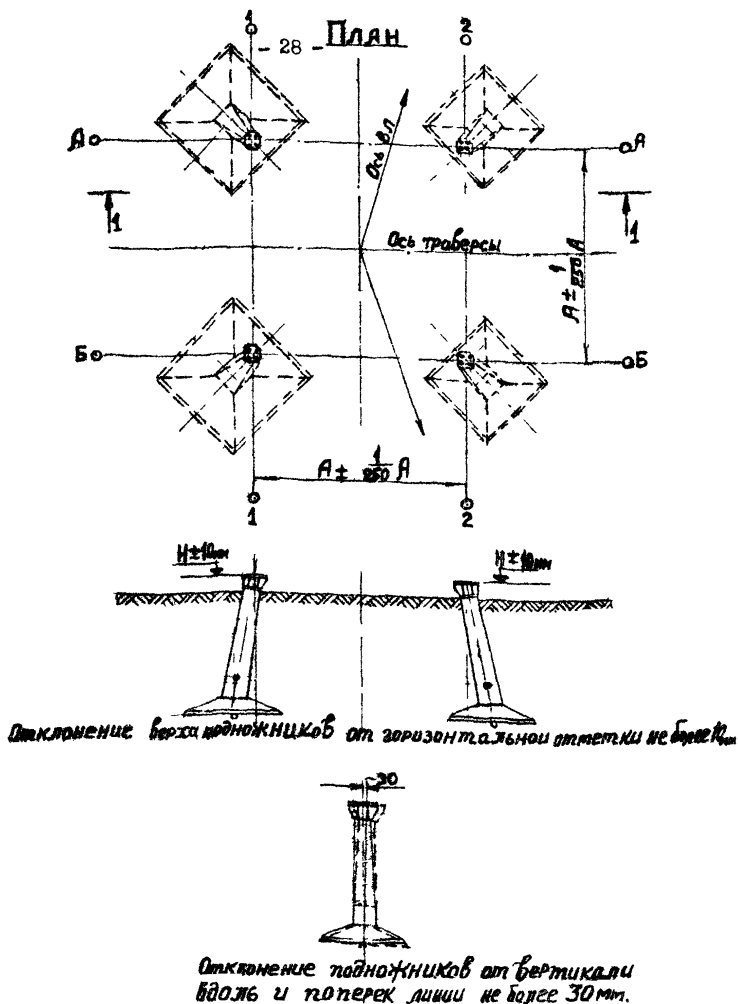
Нормы и допуски на установку фундаментов из унифицированных железобетонных элементов под металлические опоры
